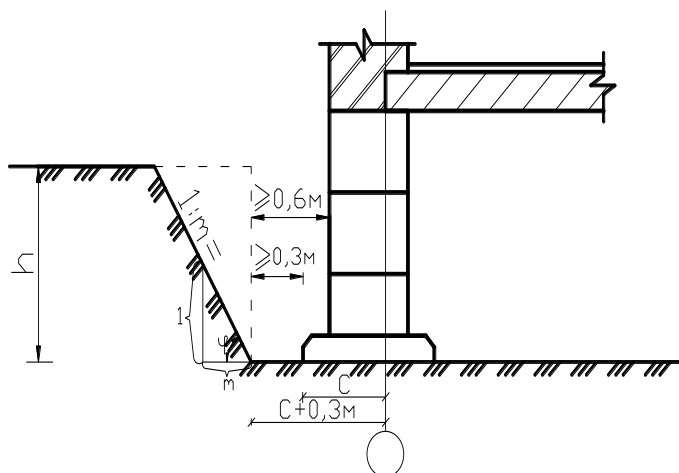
Схема расположения конструкции фундамента в котловане
